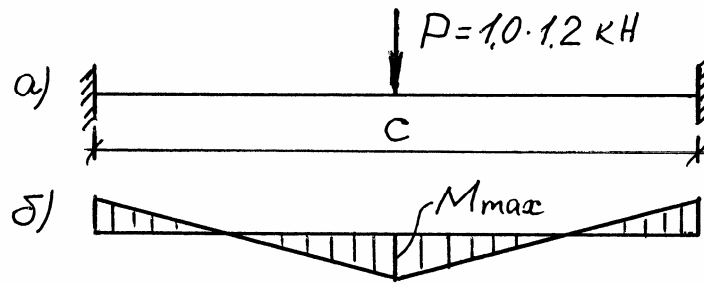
До розрахунку верхньої обшивки клеєфанерної панелі:
